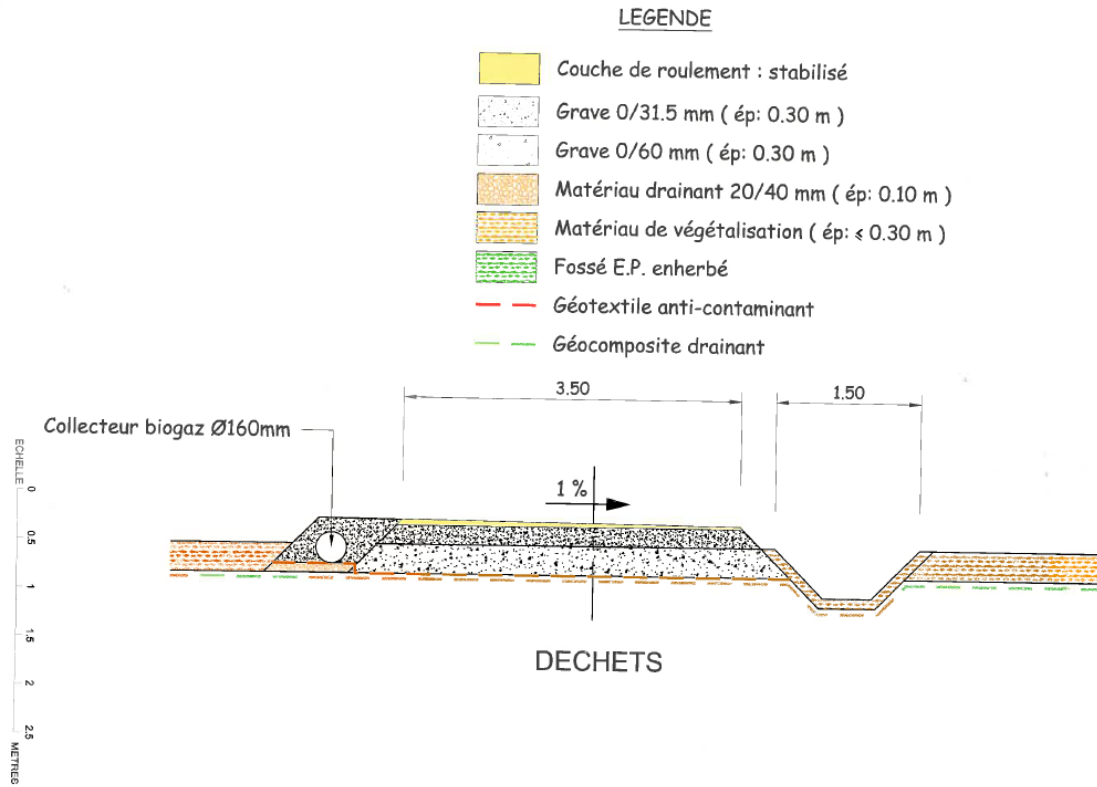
Coupe type de chaussée sur déchets (Source : Sogreah)
